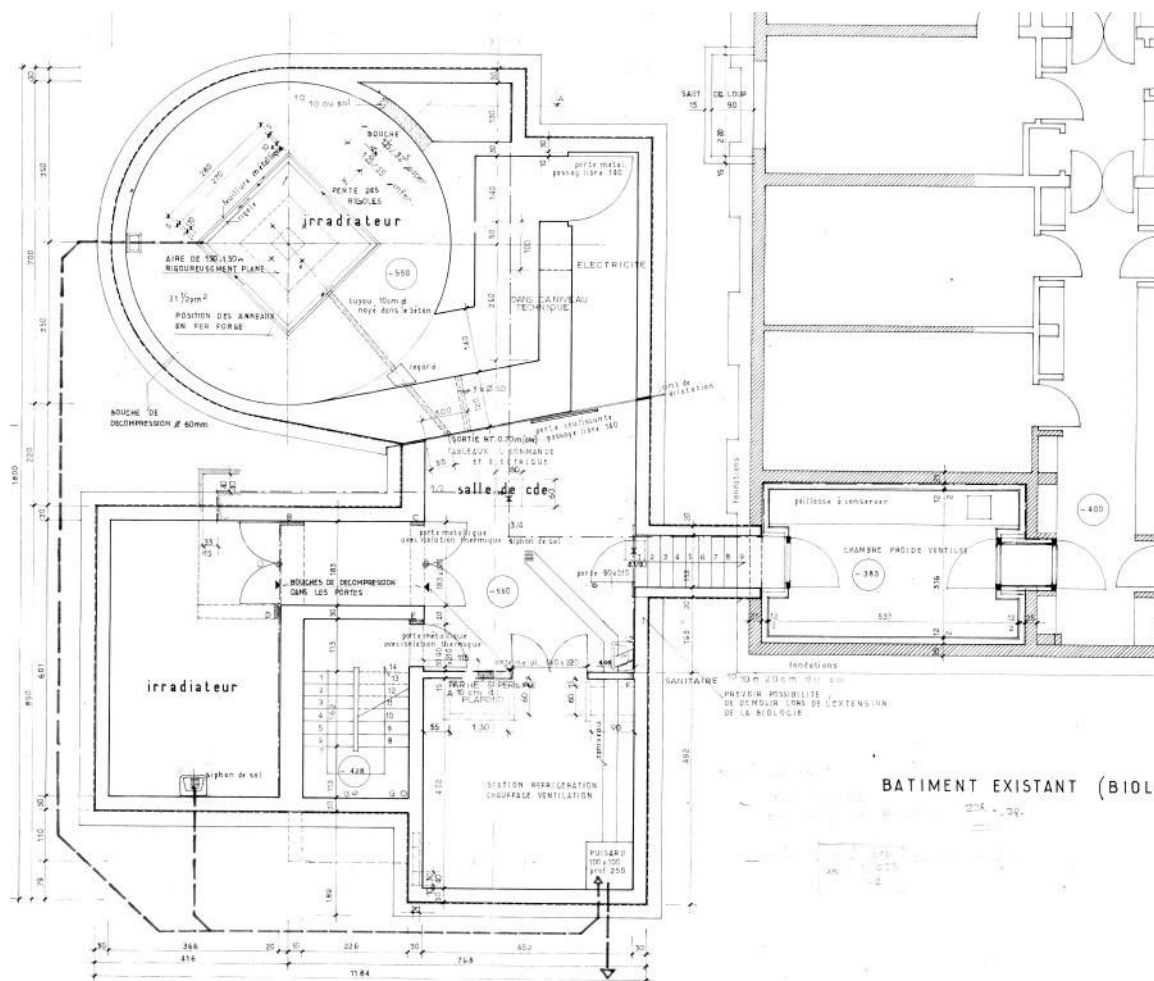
Vue en plan CNB520 – Niveau -5,50
